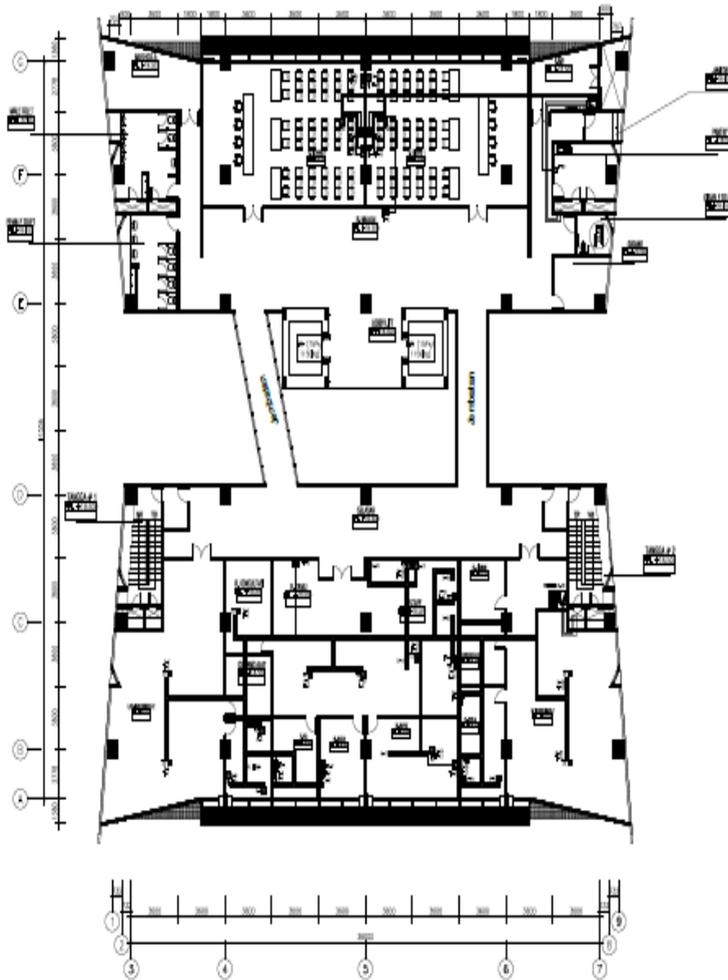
Denah lantai 2 gedung *research center* ITS
